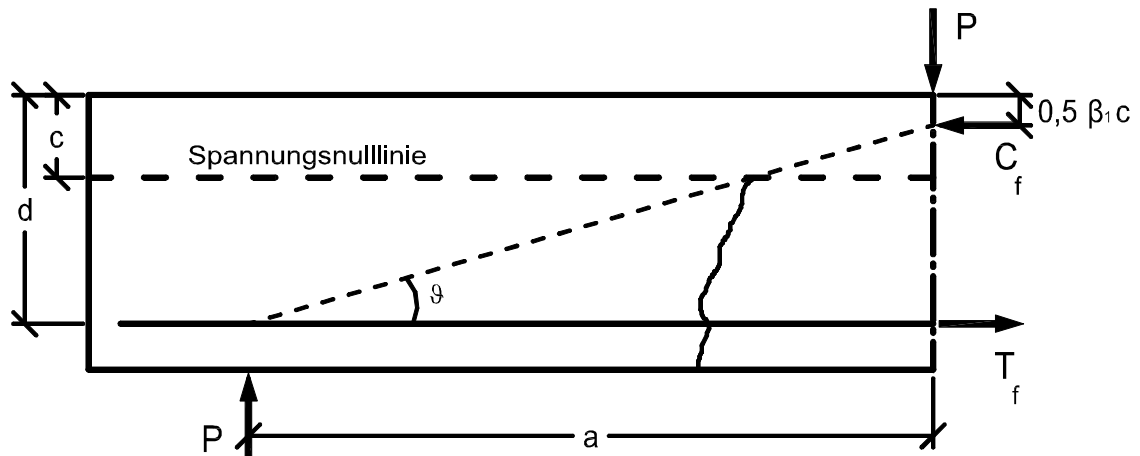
Gleichgewicht am Schubalken mit erstem Schrägriss
